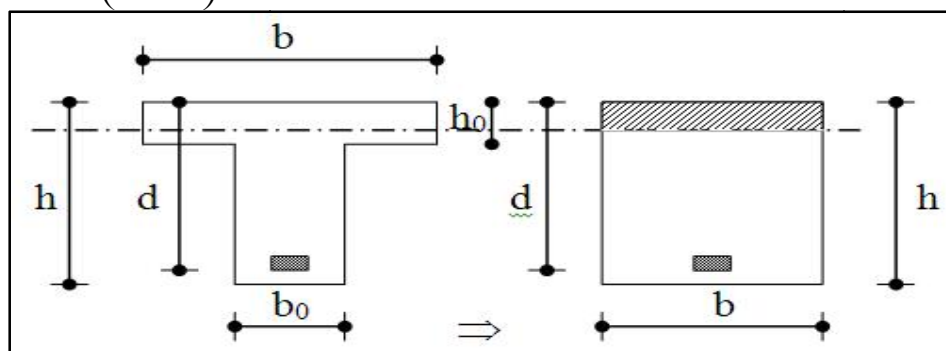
Coupe de Section Rectangulaire et Section en T.
